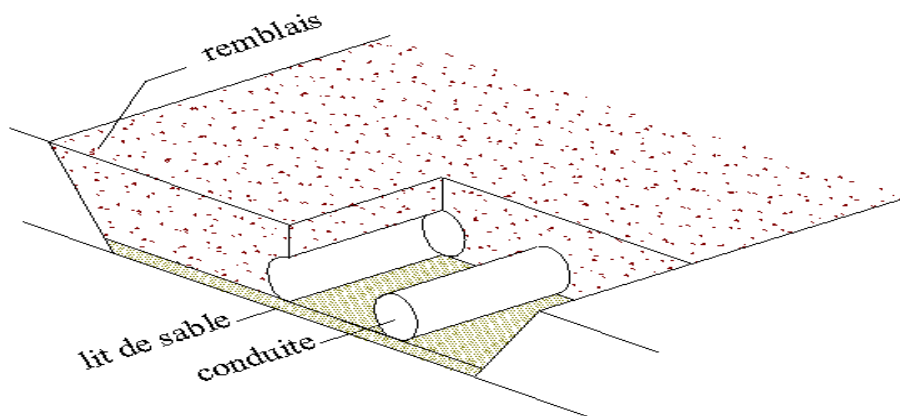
Coupe transversale d'une tranchée avec la mise en place de la conduite
